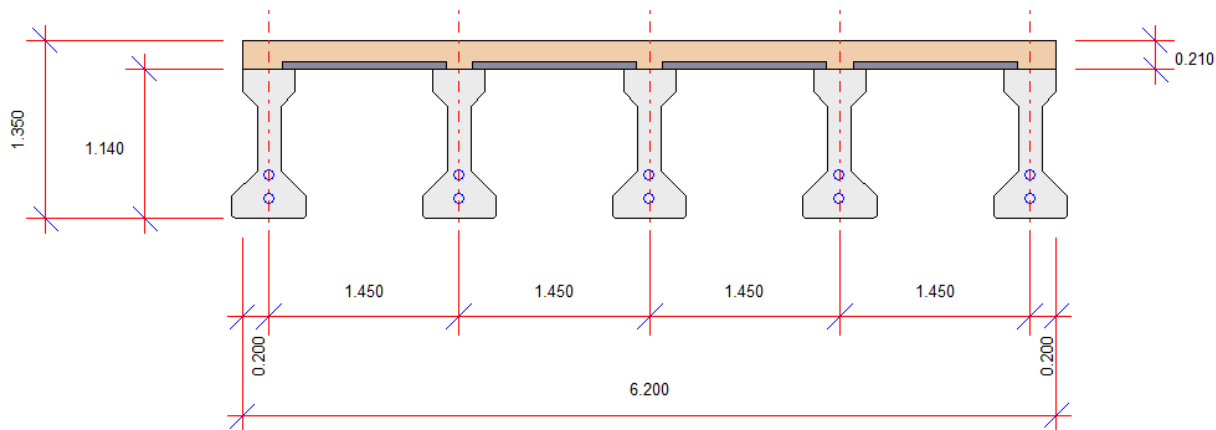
Sección tipo tablero 6.20m. Fuente: IDOM-DEHC.
